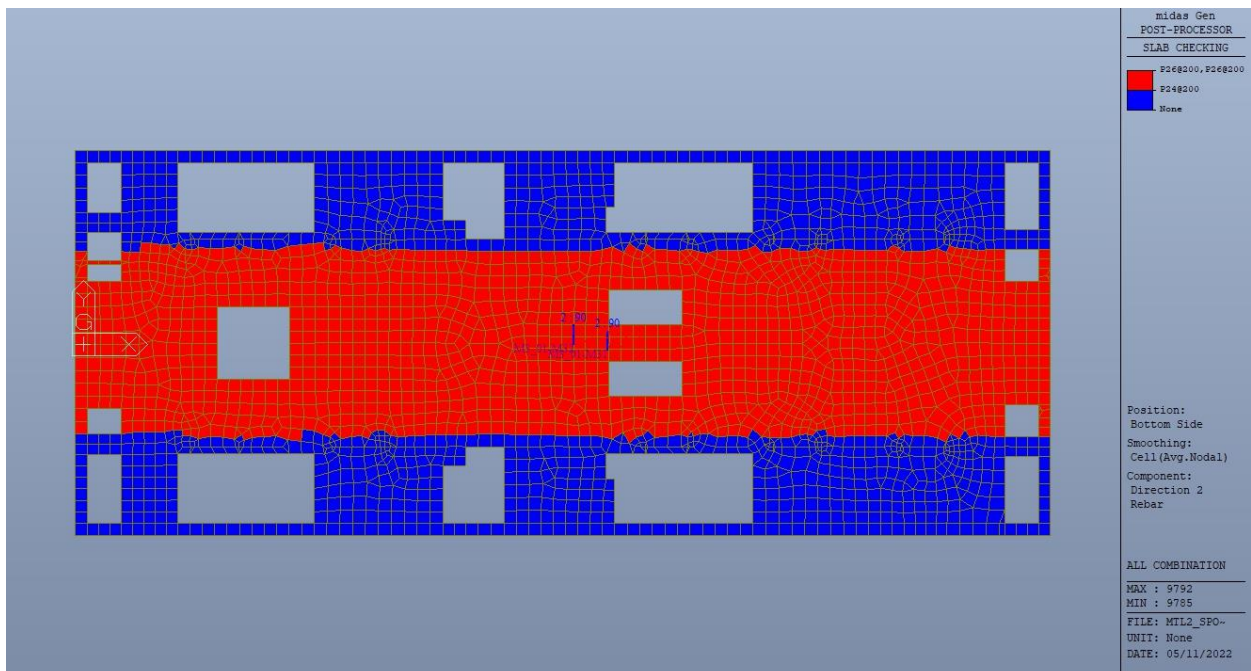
Piano mezzanino (-3) – Armatura inferiore direzione D2
